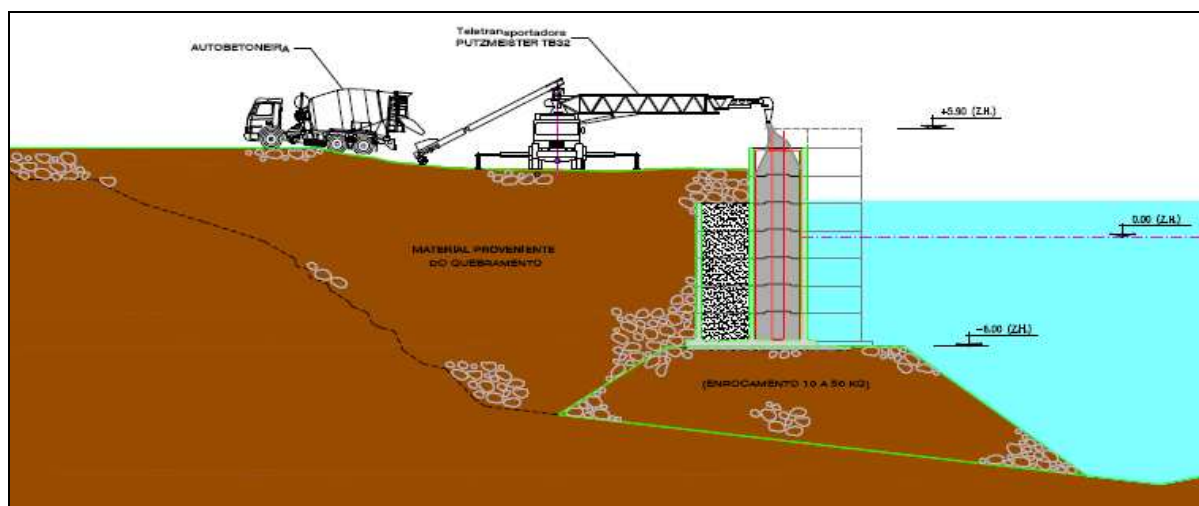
Esquema de betonagem das células/pilar. [25]
